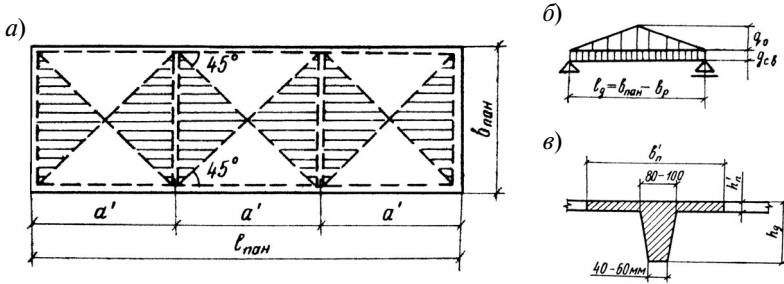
Схема загрузки диафрагмы: а — грузовая площадь; б — расчетная схема; в — поперечное сечение
